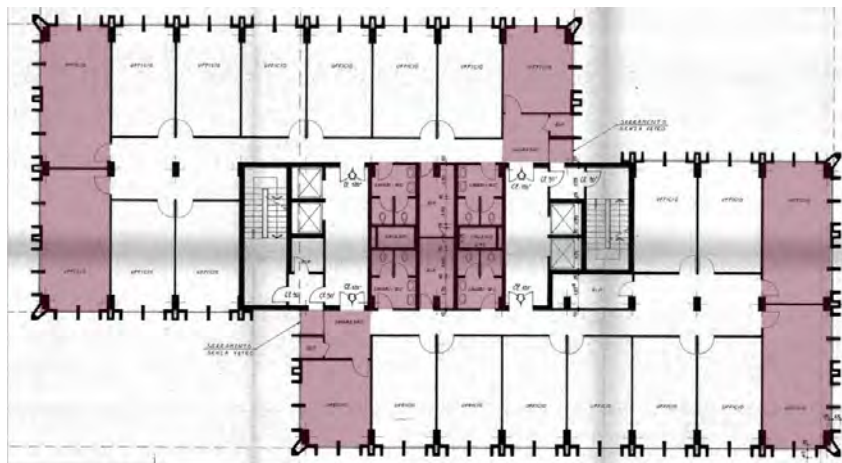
Progetto per centro direzionale a Padova. Pianta piano tipo (Prima denuncia 16/10/86, estratto tav.5)
